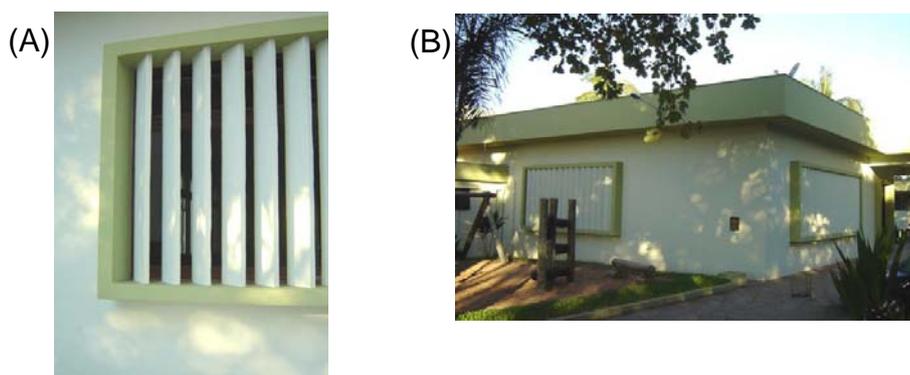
Vistas externas – (A) *brise* limitado por moldura (B) fachadas Norte e Oeste respectivamente
